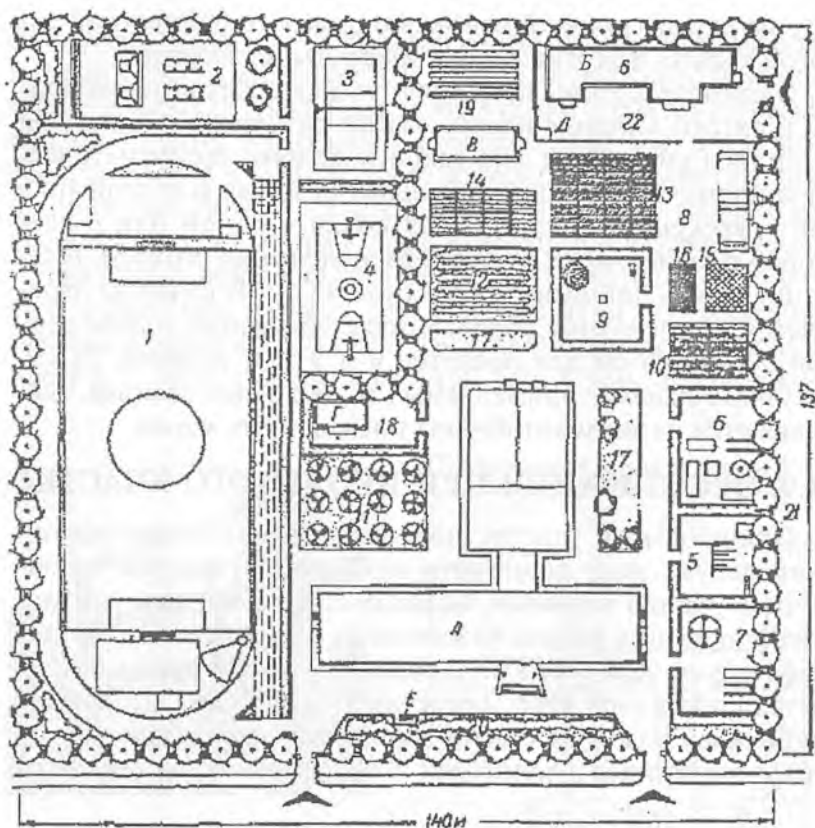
Схема генерального плана школьного участка: А — здание школы, Б — хозяйственный корпус, В — теплица, Г — теневой навес, Д — сарай, Е — флагшток; 1 — спортивное ядро, 2 — площадка для подвижных игр, 3 — волейбольная площадка, 4 — баскетбольная площадка, 5 — гимнастическая площадка, 6 — площадка для детских спортивных развлечений (I—IV кл.), то же (V—IX кл.), 8 — зоологическая площадка, 9 — географическая и метеорологическая площадка, 10 — участок начальных классов, 11 — плодово-ягодный сад, 12 — питомник плодово-ягодных и декоративных растений, 13 — участок овощных культур, 14 — участок полевых культур, 15 — участок семян, 16 — коллекционный участок, 17 — участок декоративных растений и цветов, 18 — площадка занятий на воздухе, 19 — парник, 20 — газоны и декоративная зелень, 21 — ветрозащитная зеленая полоса, 22 — хозяйственный двор
